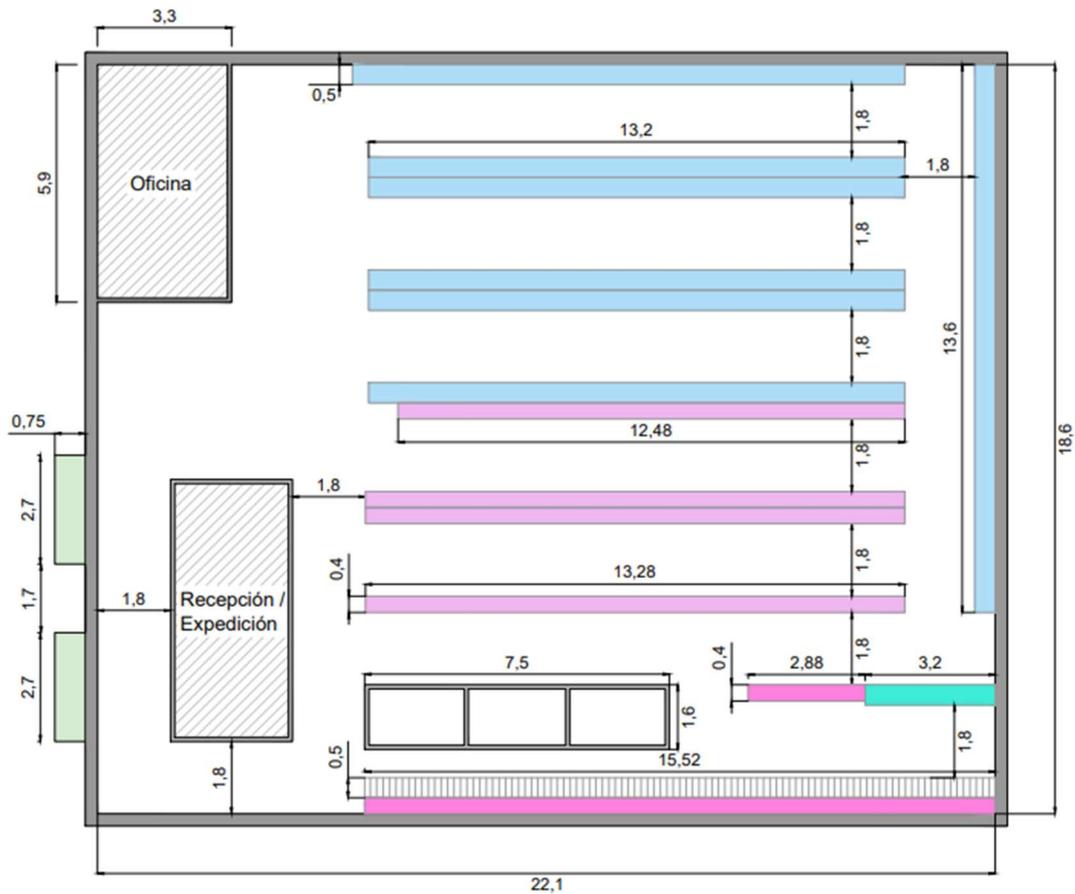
Distribución en planta segunda configuración (Elaboración propia)
